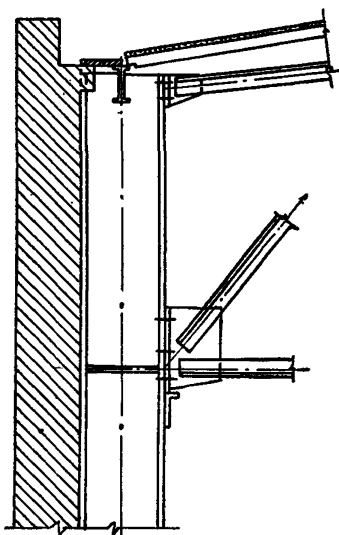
Жесткое соединение фермы с колонной в здании со стальным каркасом
